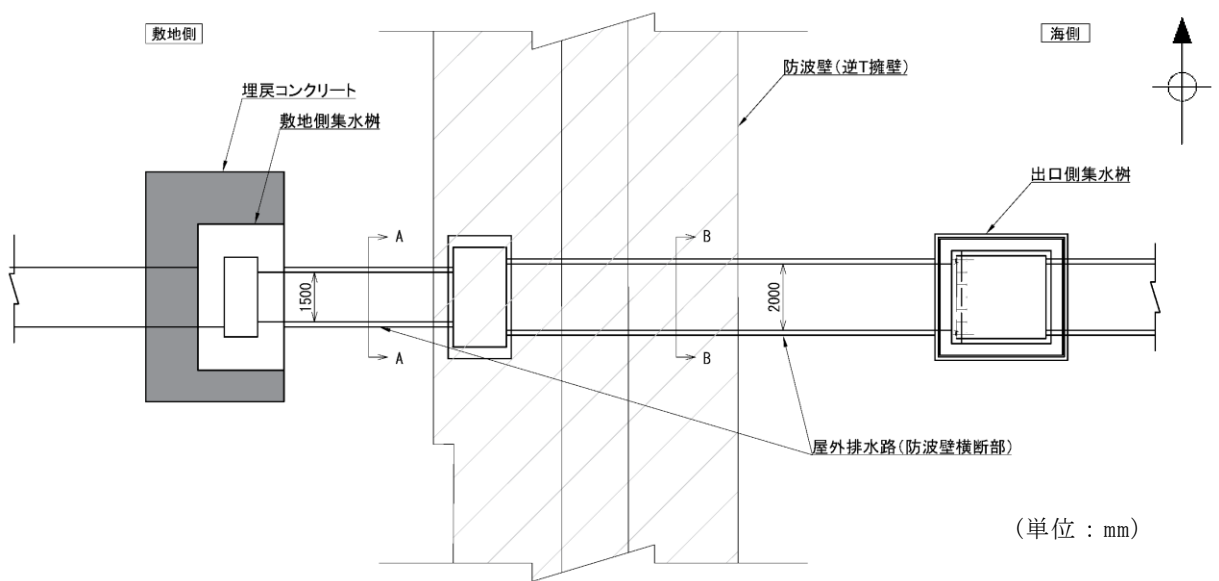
屋外排水路（防波壁横断部）の概略平面図
